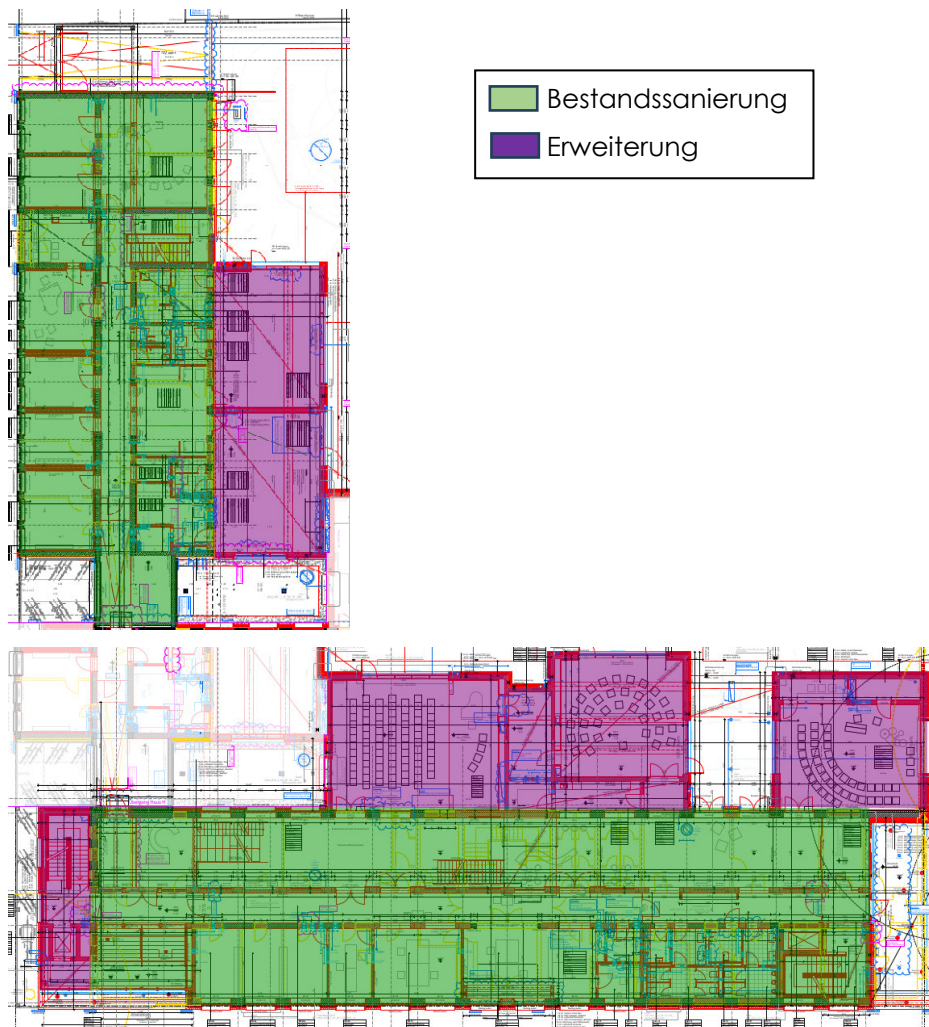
Grundrissausschnitt 1. OG, Entwurfsplanung v. 10.07.2025
